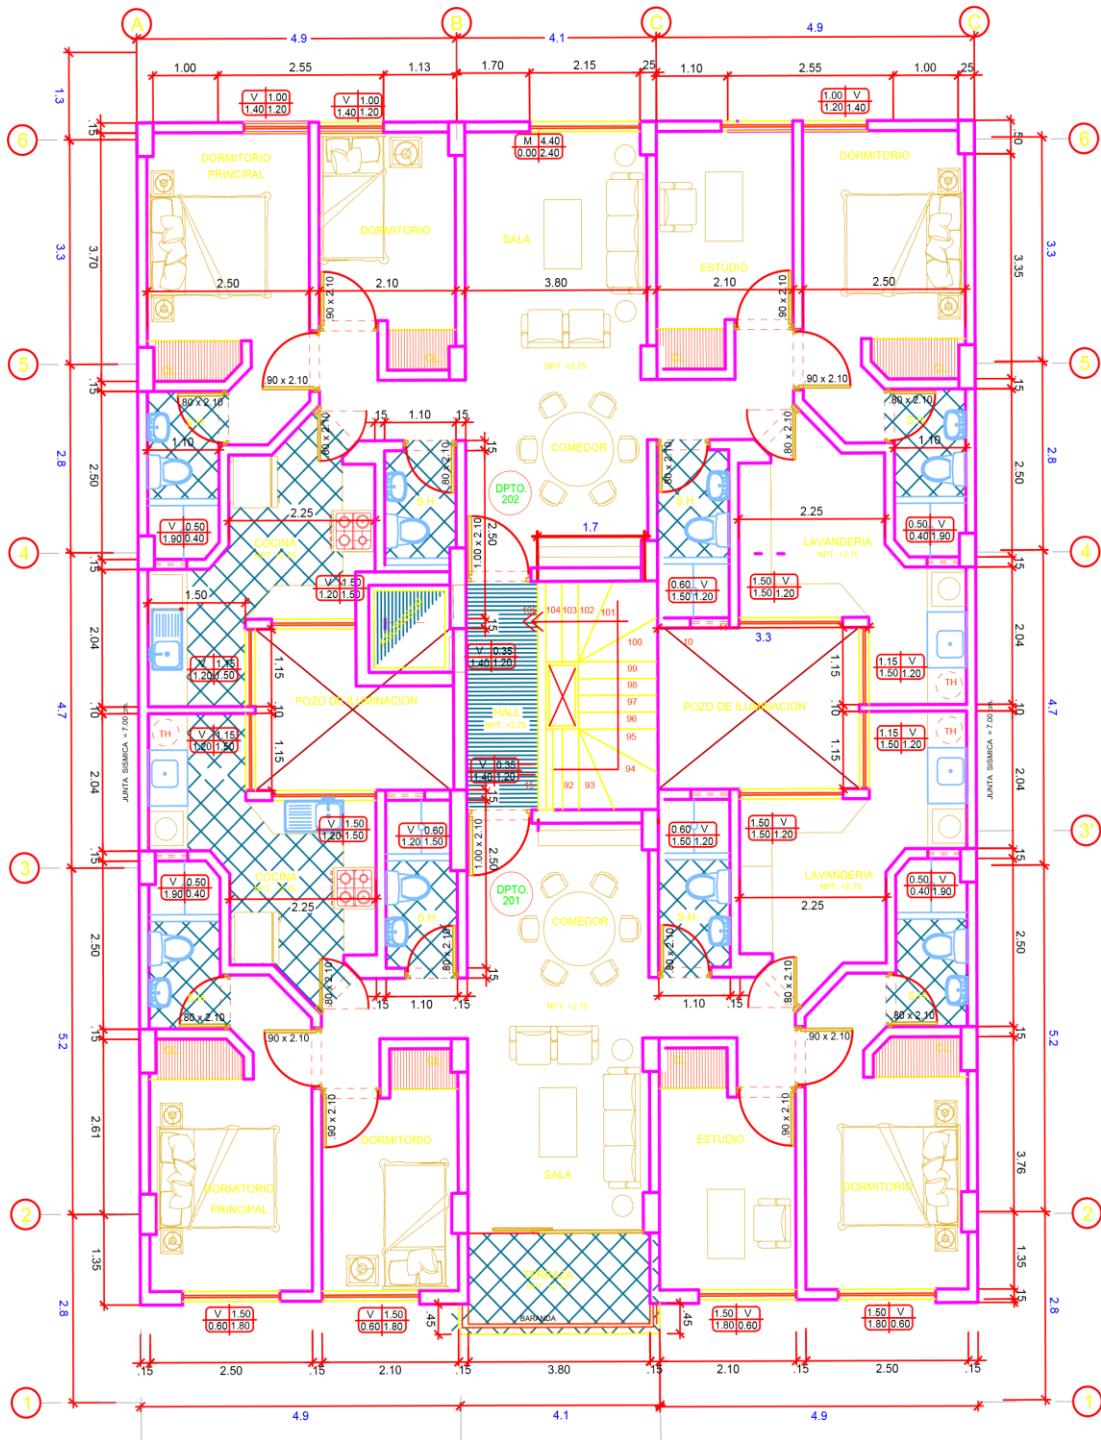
Planta tipo 1-9 piso el cual consta 2 departamentos, 2 conductos de ventilación, ascensor central y gradas.
